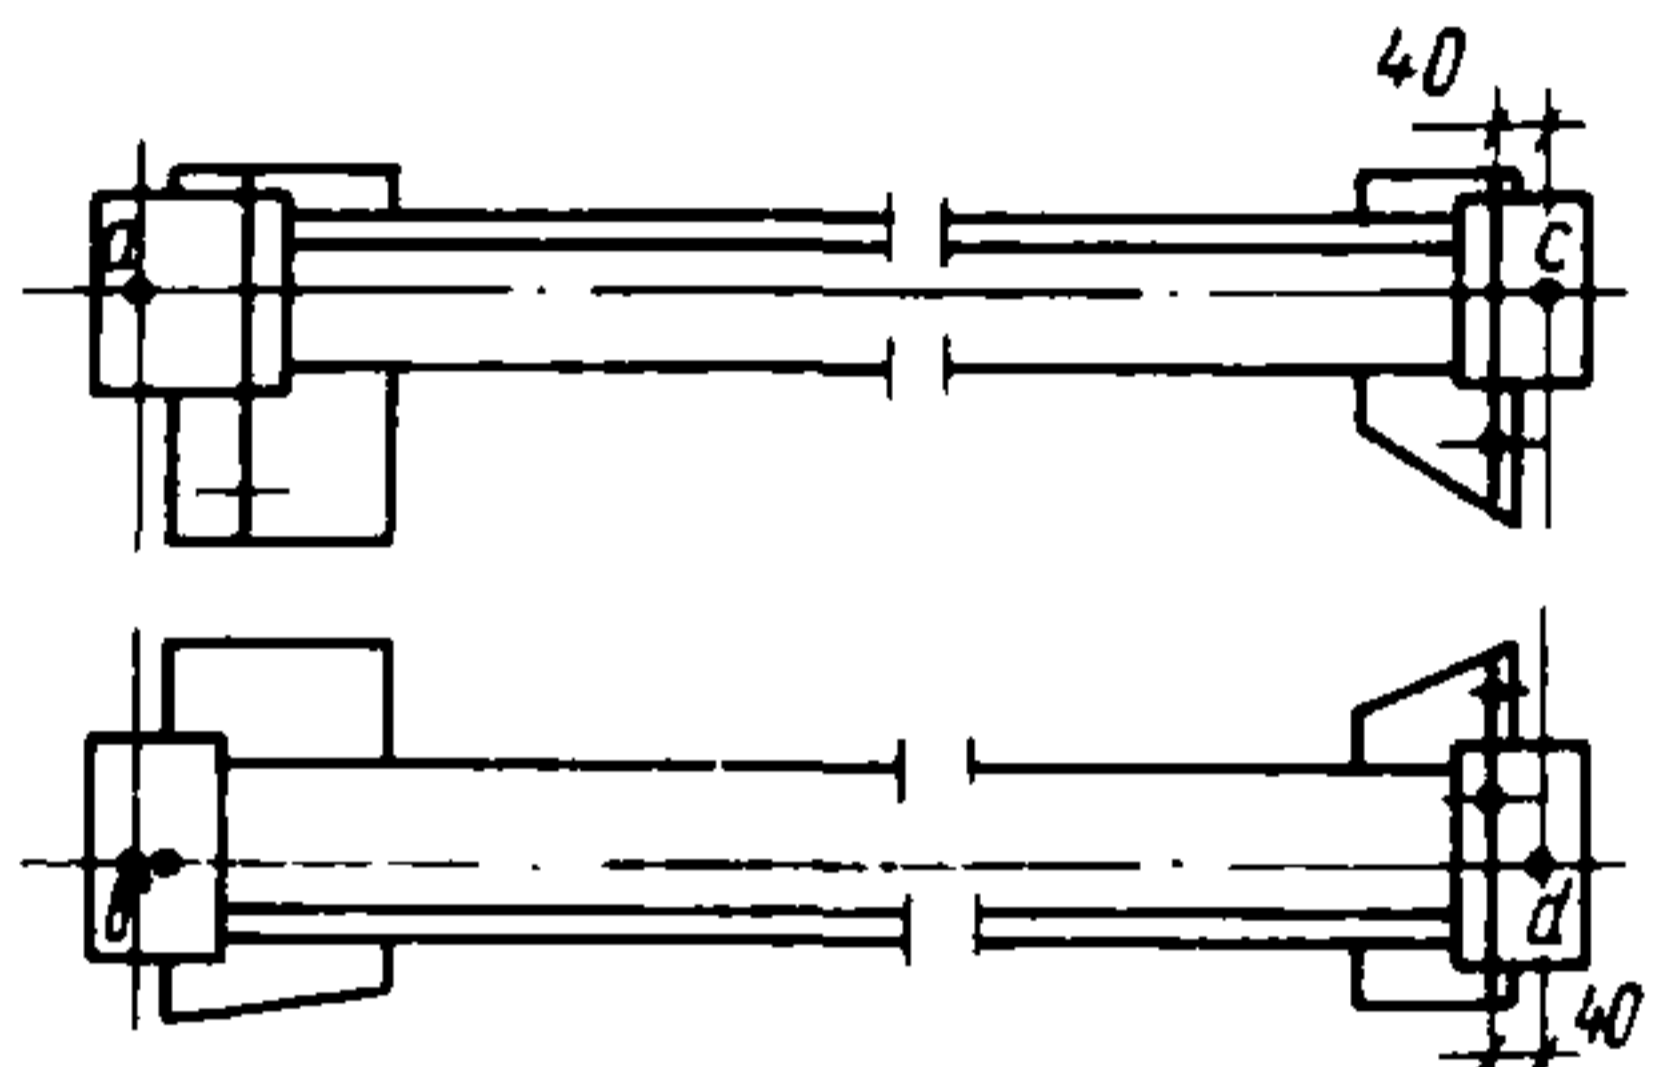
Установка фасонки опорного узла и монтажного стыка
